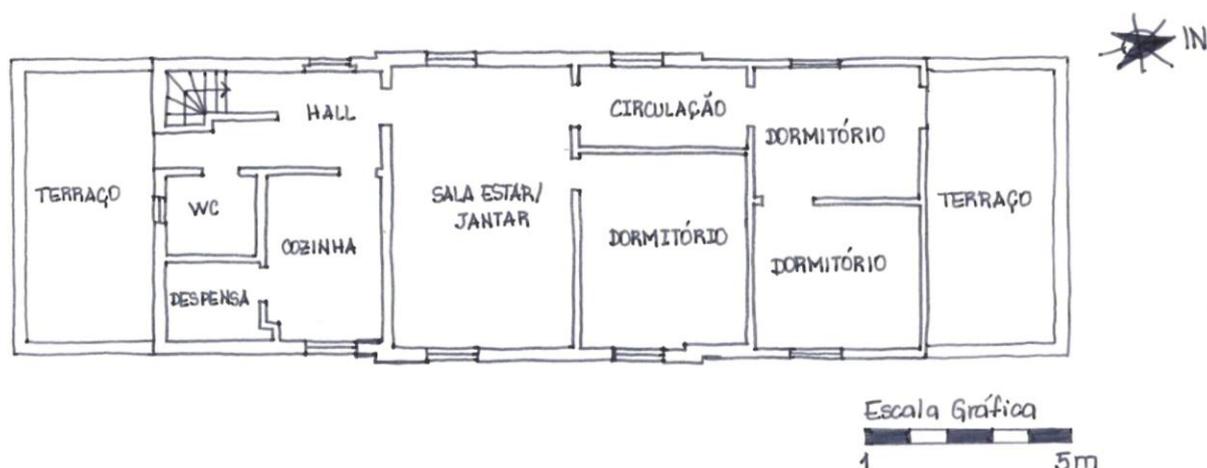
Planta baixa da edificação da Estação ferroviária de Santiago – Pavimento superior.
